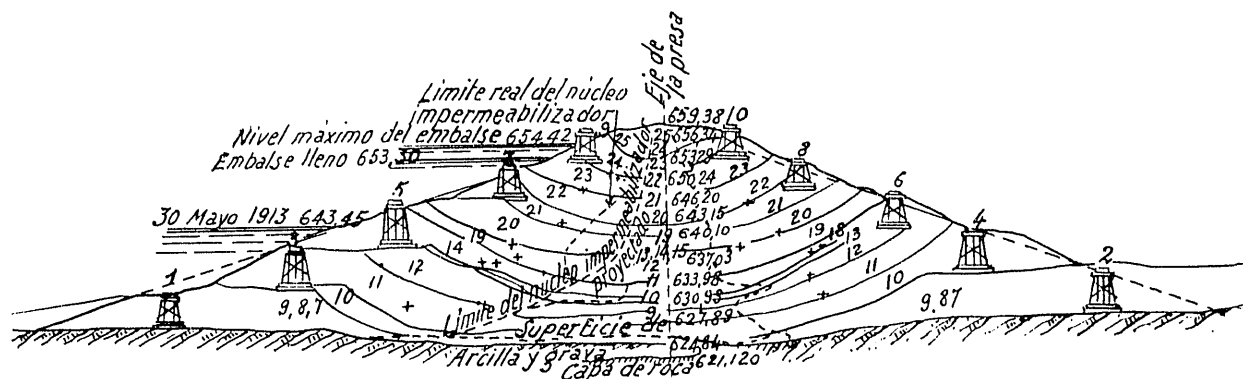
Presa de Somerset, en Massachussets (E. U.), de 32 m de altura y 634 m de longitud. Los números 9 al 25 indican las semanas desde el comienzo de los trabajos. En la parte central, al lado de la indicación de las semanas, figuran las ordenadas de la superficie de la presa en ejecución. Los capataces se numeran del 1 al 10. La altura de éstos es de 4,60 a 6,10 m
